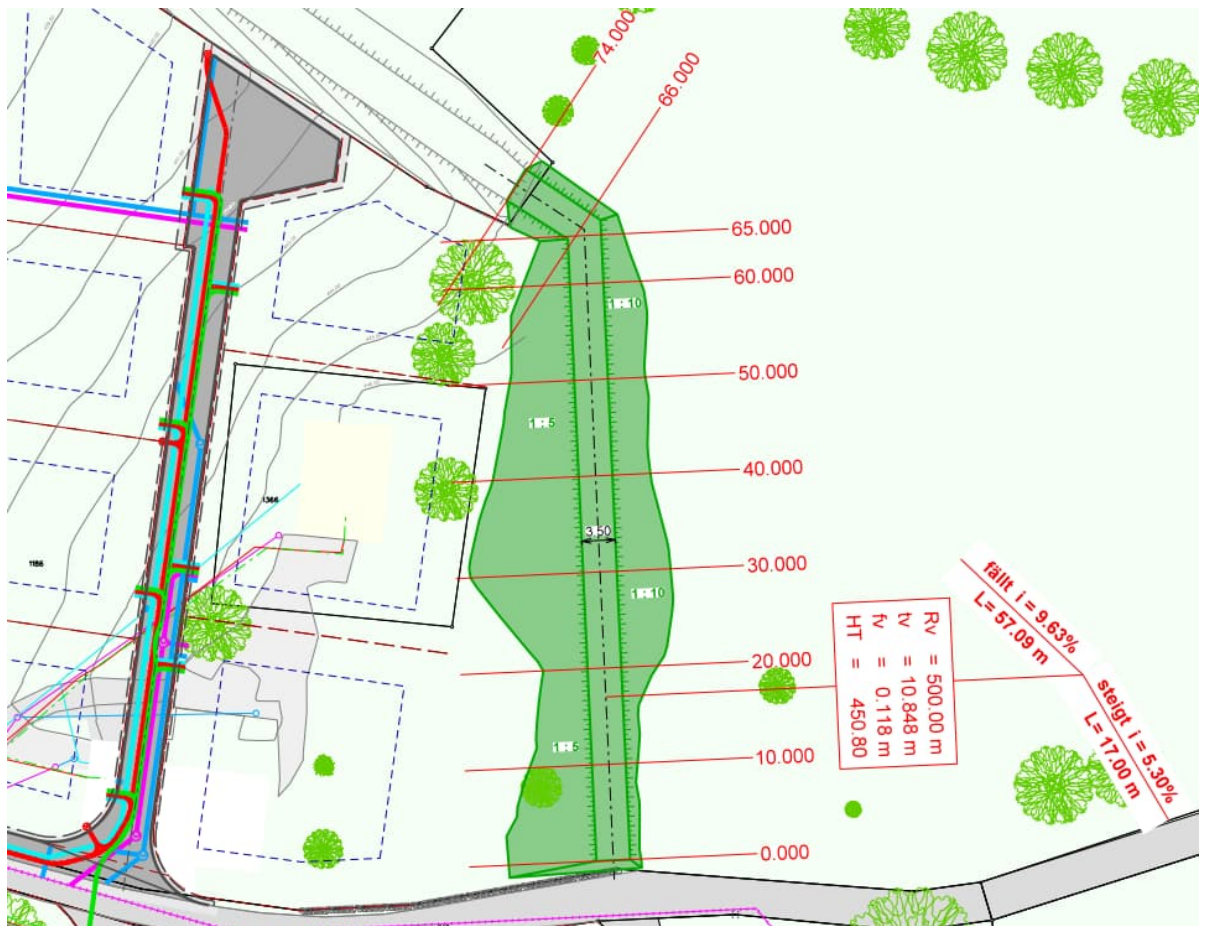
Ausschnitt Situation Damm, Plan Nr. 1331 03.04-3
